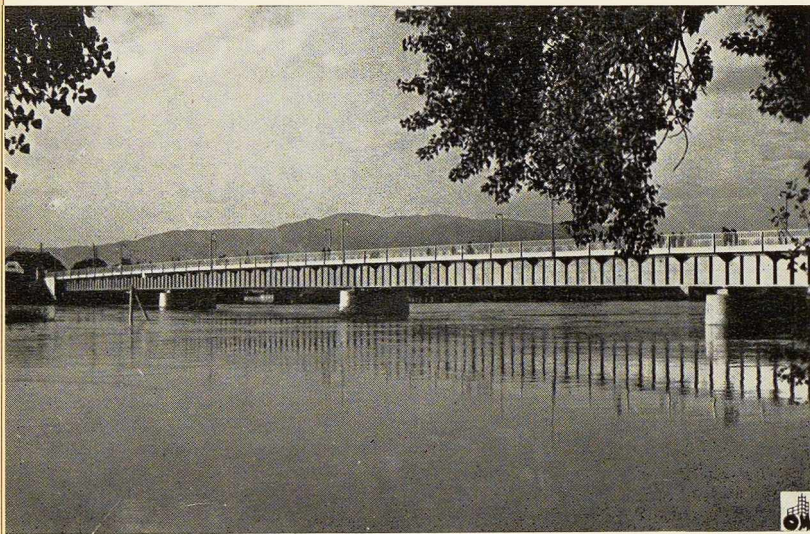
Pont sur la Save à Zagreb (Yougoslavie) d'une longueur totale de 220 mètres.
